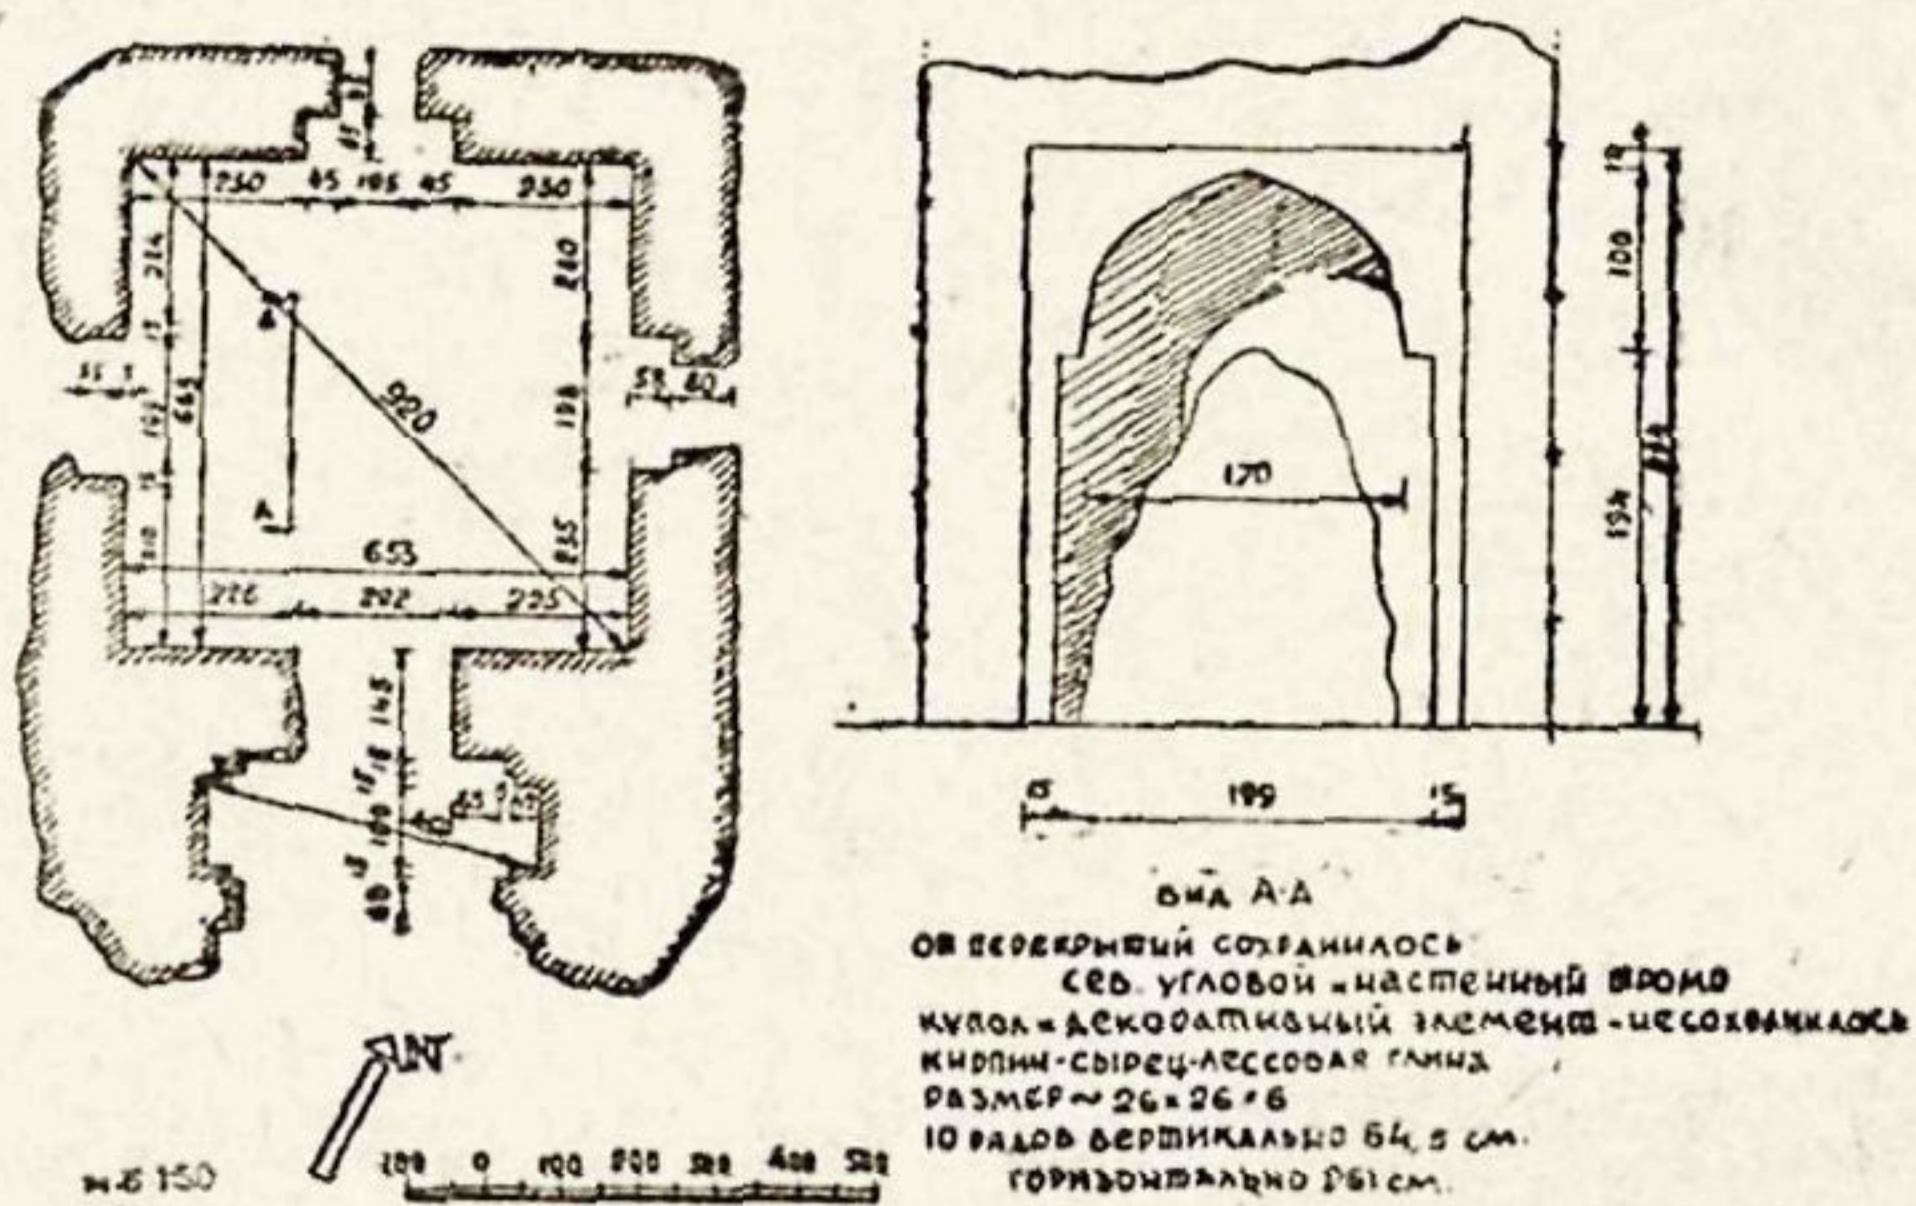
План сырцового здания № 15 и обмер одной из стеновых ниш (ныне пролом).
